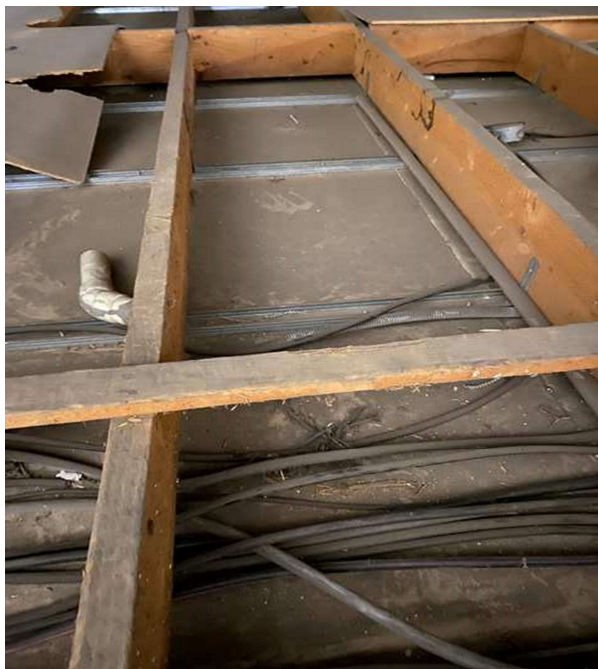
Faux plafond des bureaux, sanitaires et ateliers
